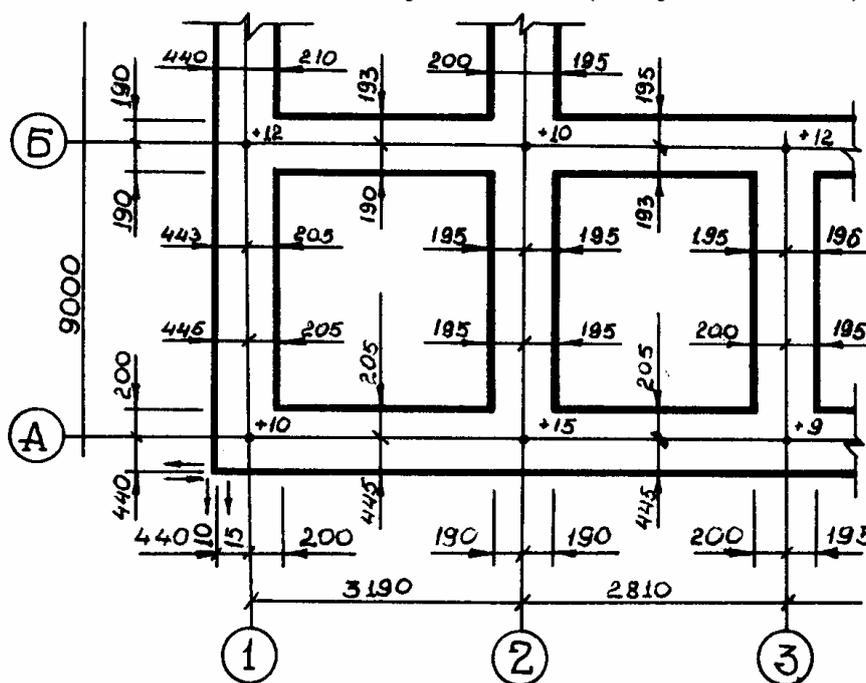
Фрагмент исполнительной схемы кирпичной кладки под перекрытие этажа
